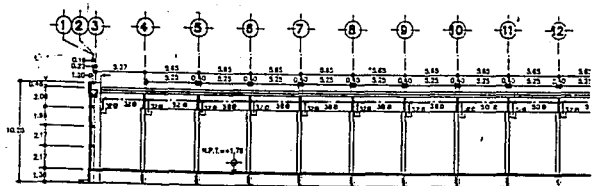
VISTA LONGITUDINAL DE MARCOS DE ACCESO.
